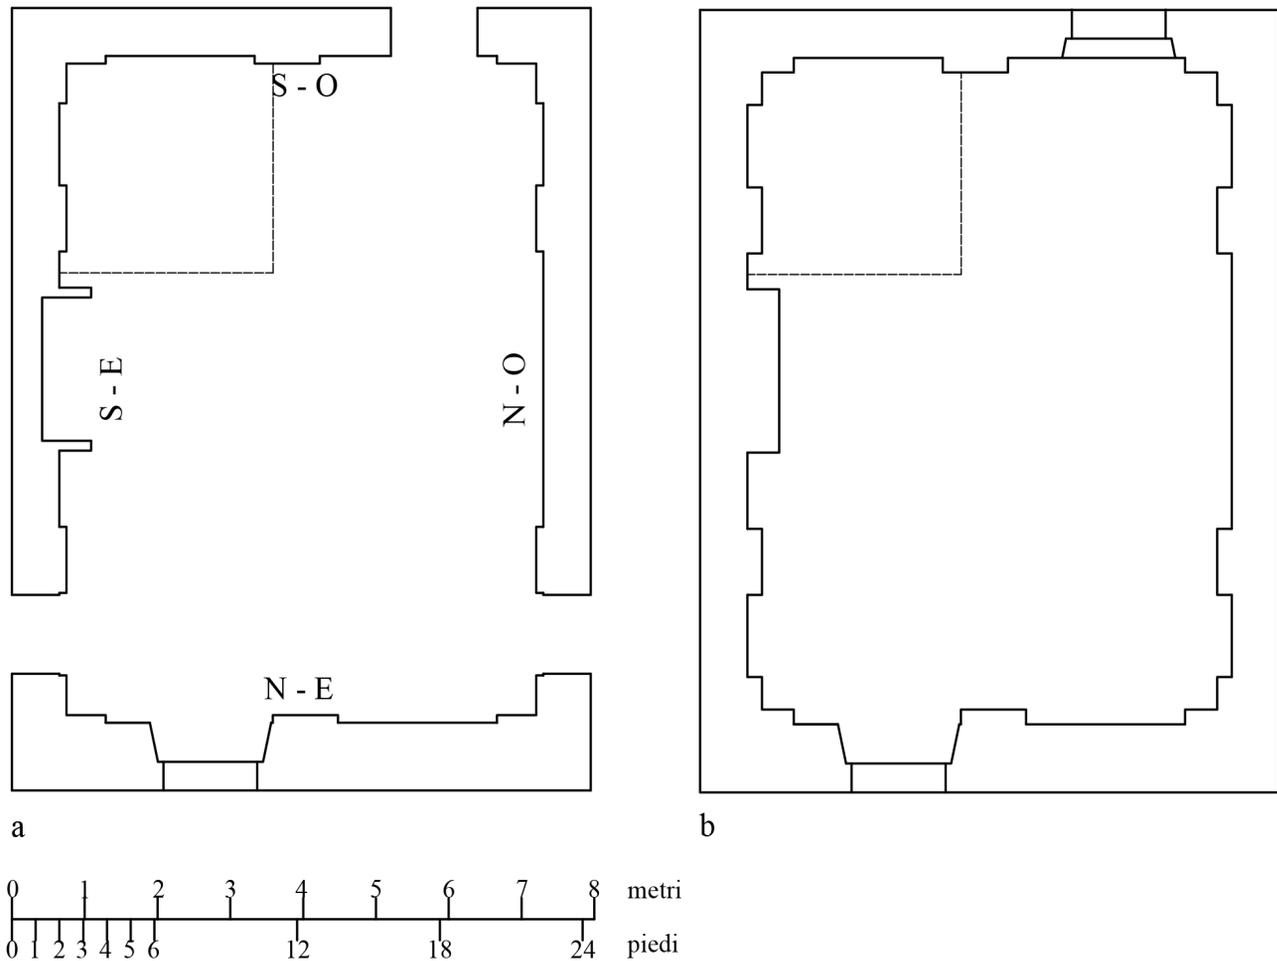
Ipotesi di restituzione dell'assetto delle bucaure della camera della duchessa d'Étampes nel 1544, con tratteggiato lo spazio d'uso del letto. a: sezione sul registro inferiore; b: sezione sul registro superiore (elaborazione grafica dell'autore).
